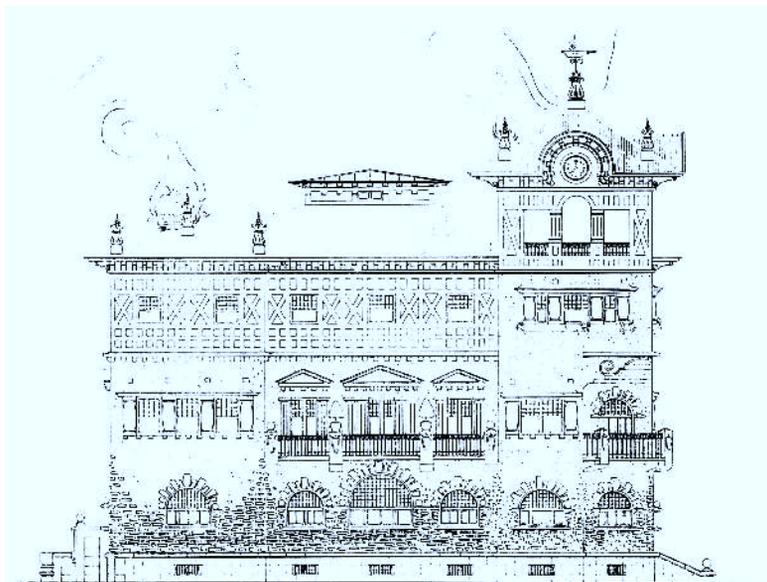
Proyecto para el Ayuntamiento de Carranza realizado en 1924 por el arquitecto Julio Sáenz de Barés. Alzado de la fachada lateral derecha. (Edificio no construido).
